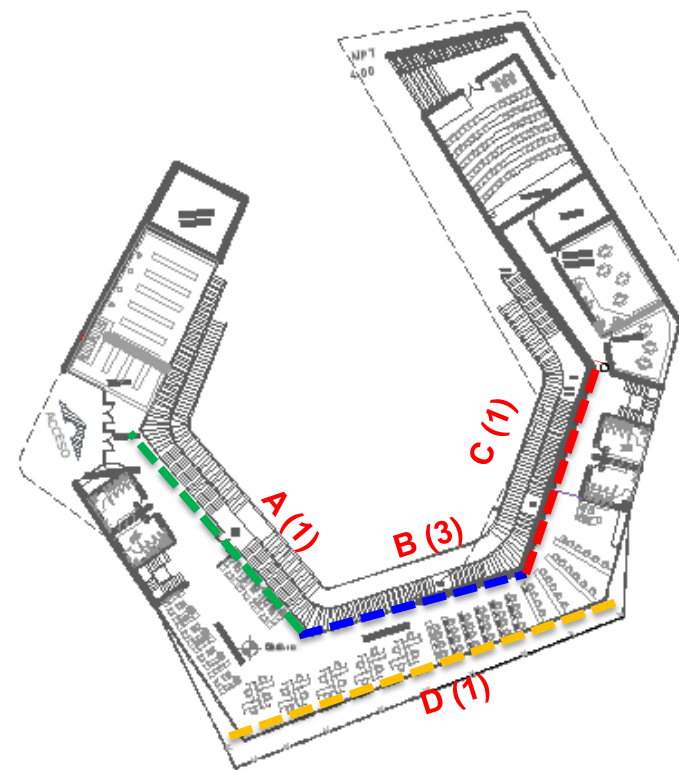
Imagen CI . Planta Arquitectónica biblioteca (ACS, 2013)
